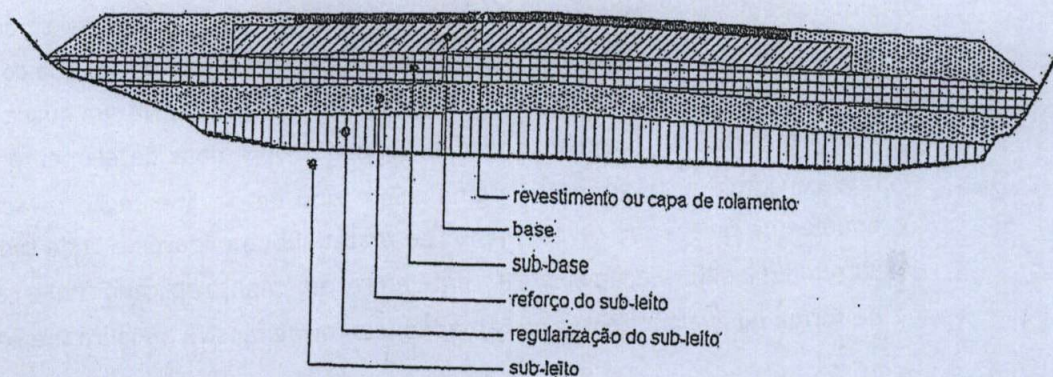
Esquema das camadas de um pavimento. FONTE: Faleiros, 2005, p. 4
